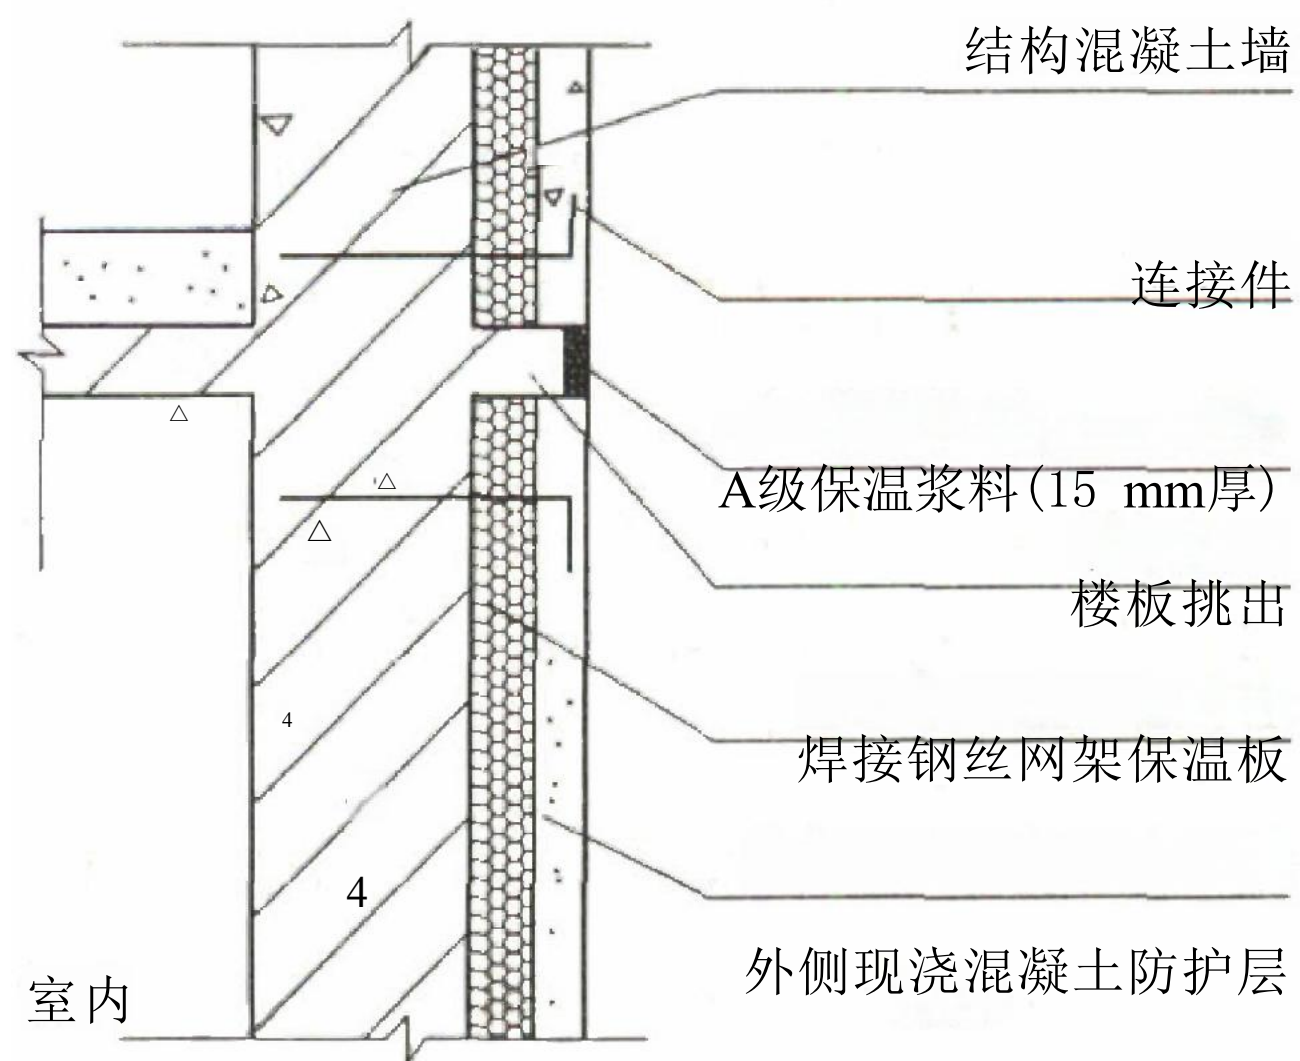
楼层间部位焊接钢丝网架保温板连接构造示意图
